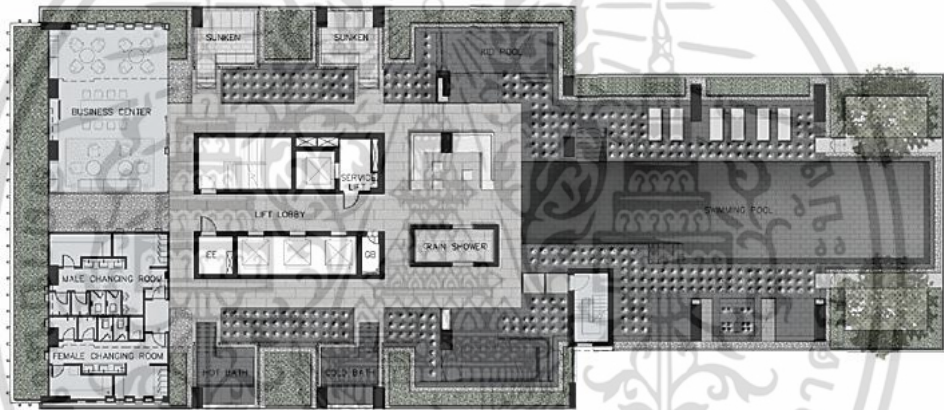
ผังโครงการ The XXXIX ชั้น 1
